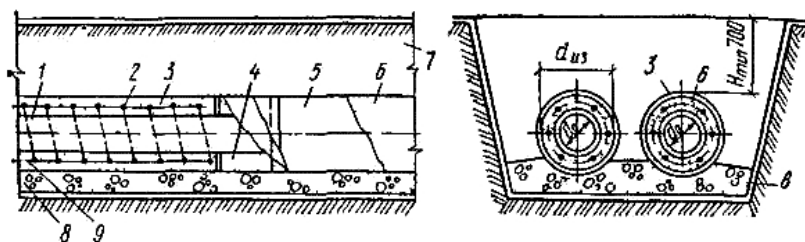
Прокладки трубопроводов в изоляции из монолитного армопенобетона:
